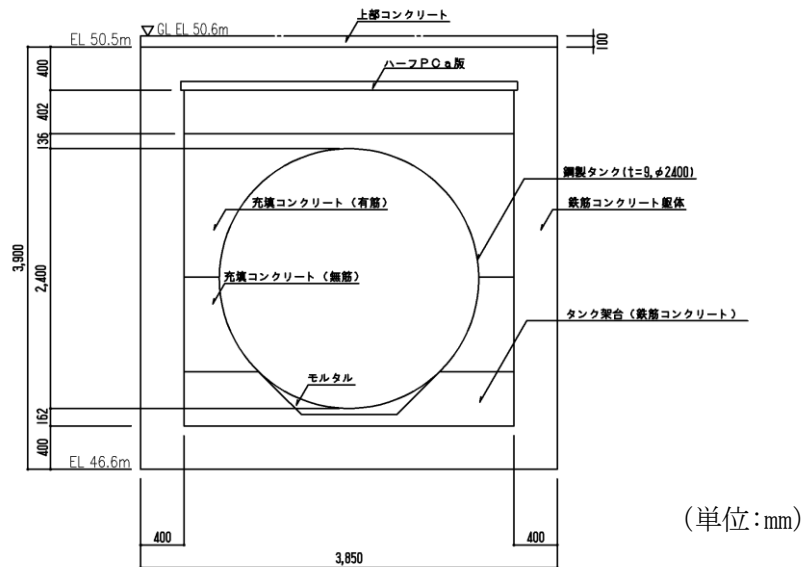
緊急時対策所用燃料地下タンク 断面図 (A-A断面)
